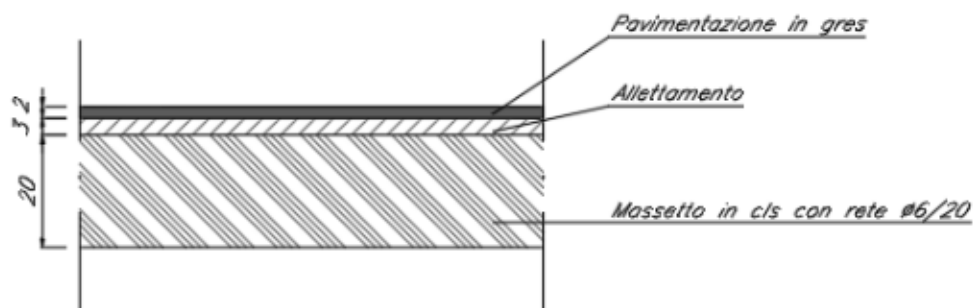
Dettaglio 3, pacchetto pavimentazione marciapiedi
